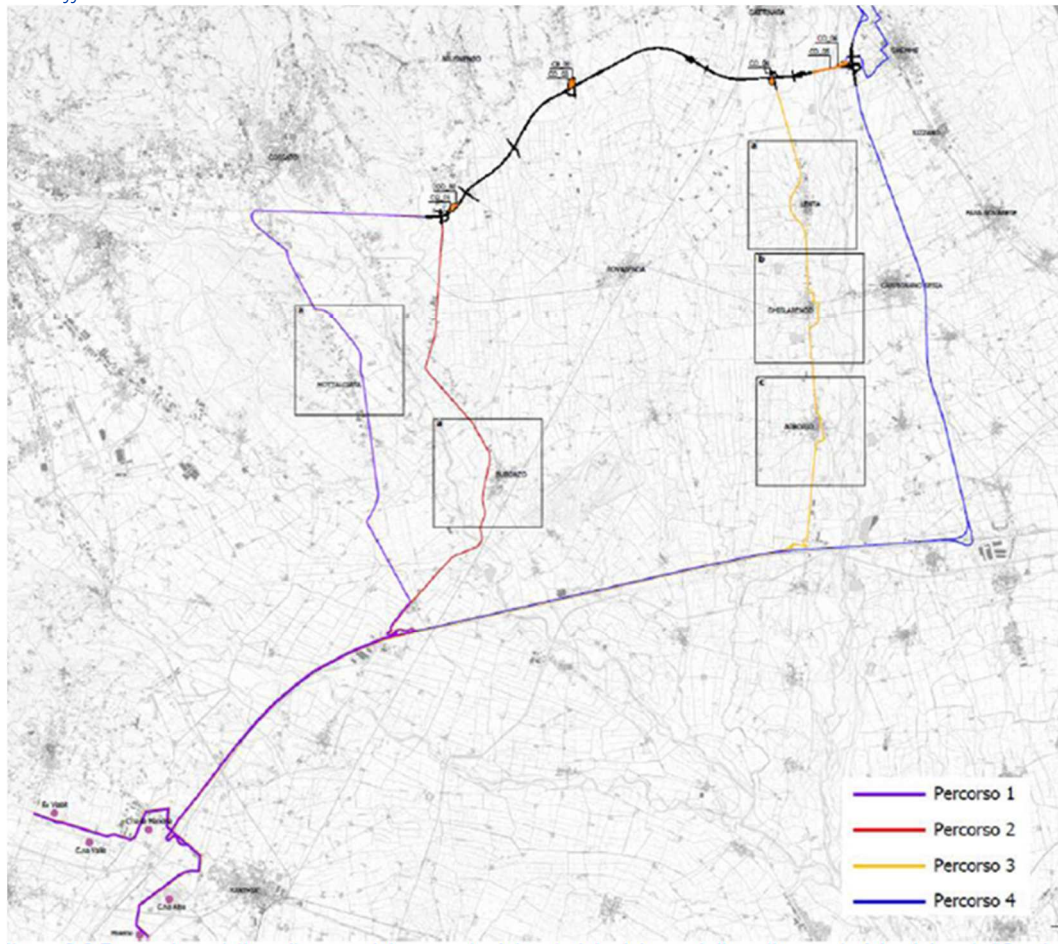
Percorsi previsti per l'approvvigionamento del materiale dei mezzi di cantiere – stralcio elaborato "Cantierizzazione: ubicazione delle aree di cantiere e viabilità di servizio"
